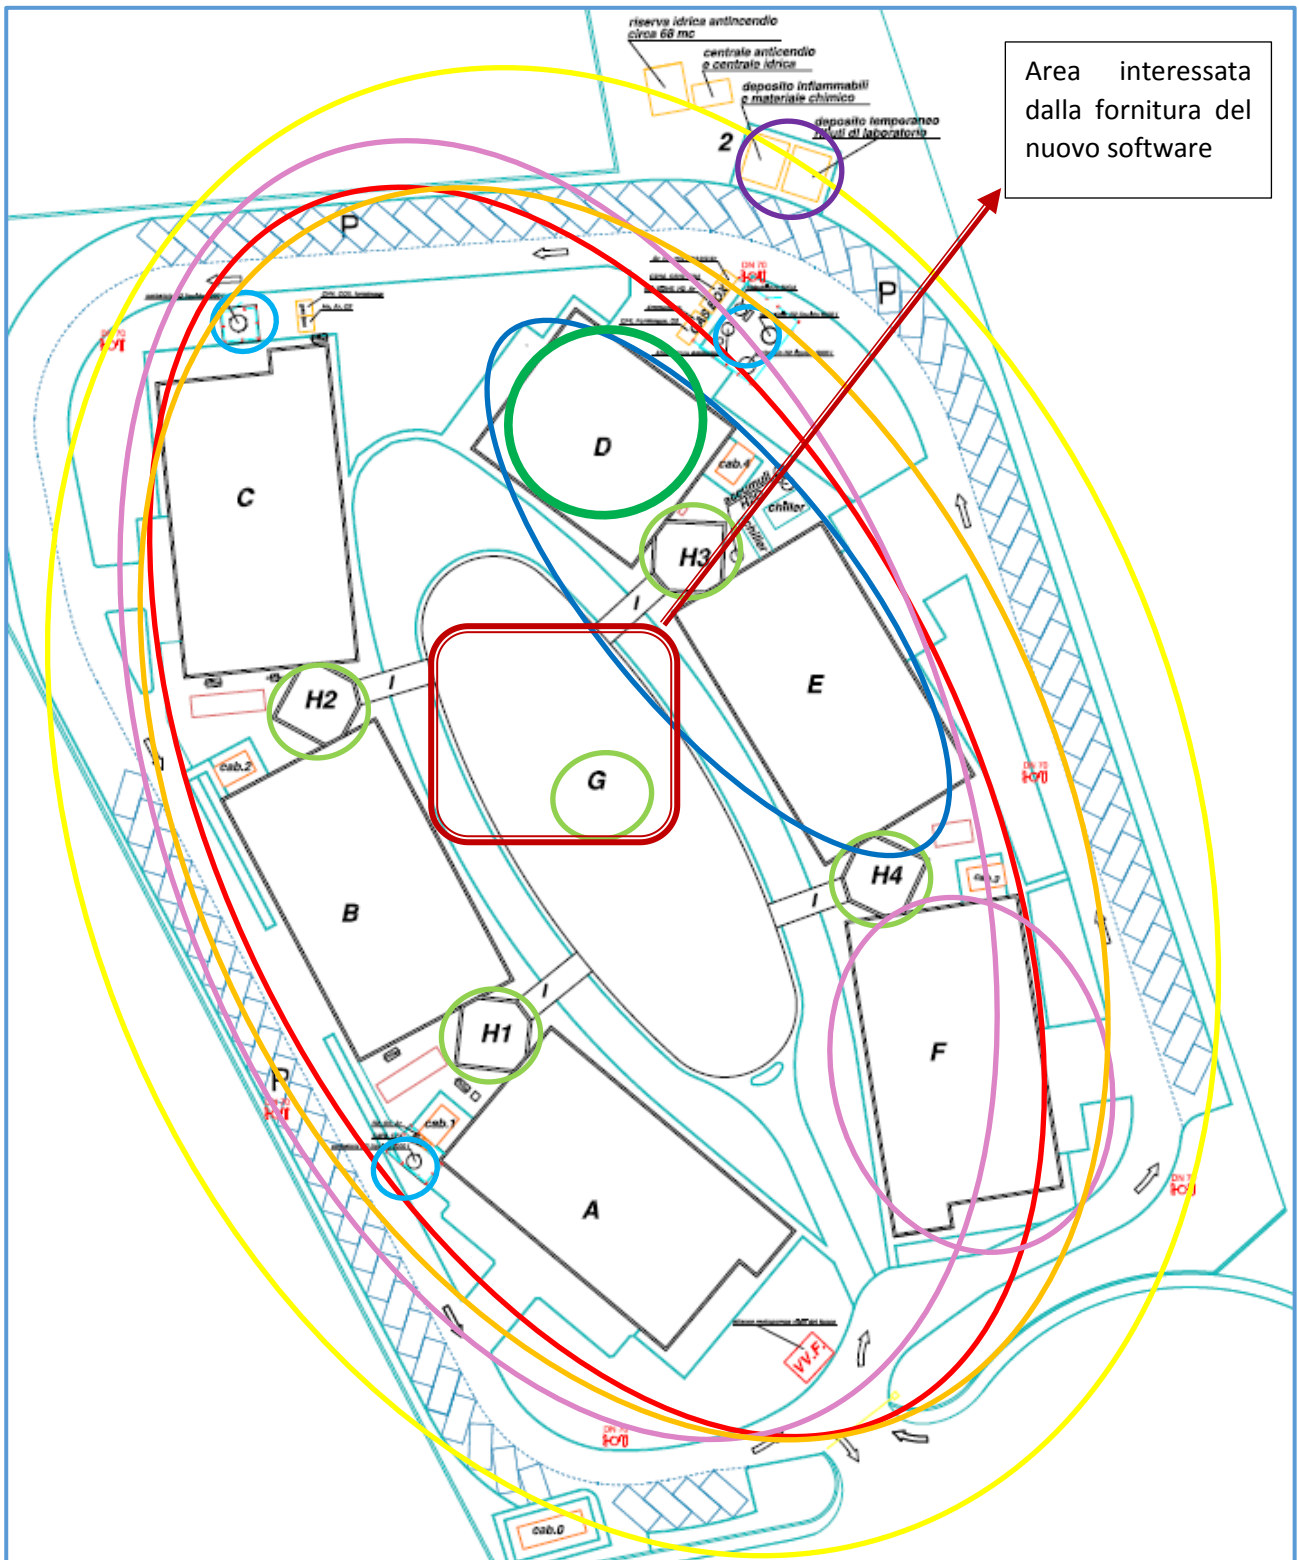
planimetria generale riportante le aree interessate dalle varie ditte di manutenzione con aggiunta dell'attività oggetto del seguente appalto
